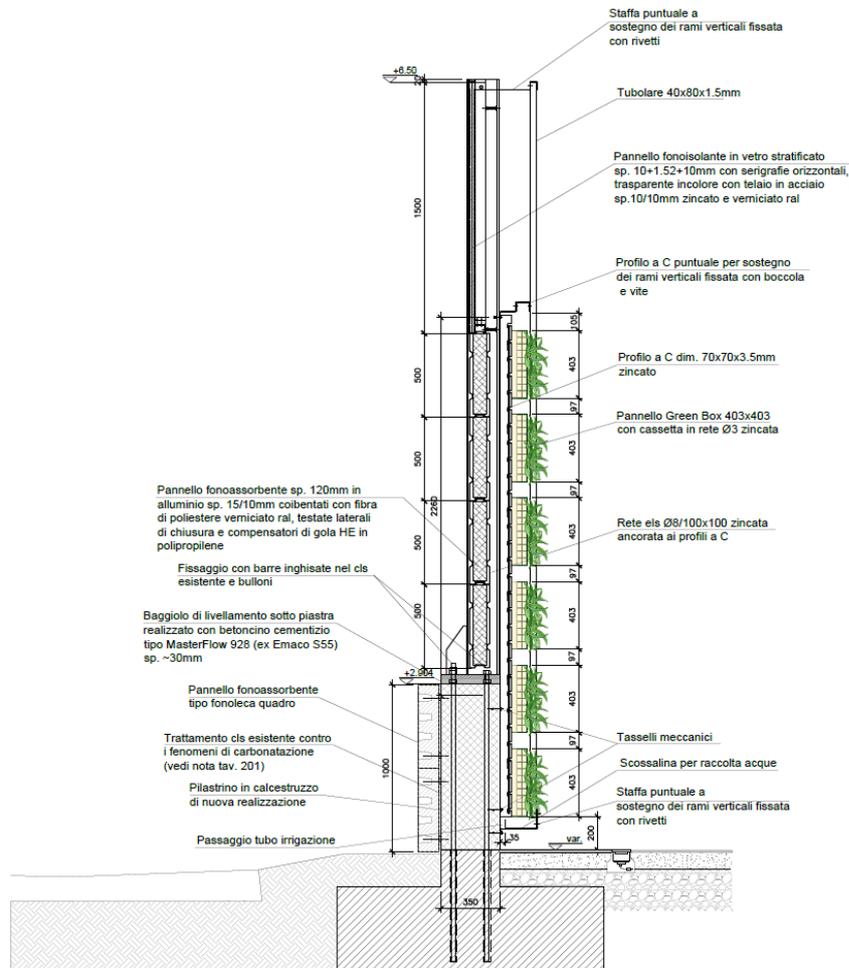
Progetto esecutivo - Protezione antifonica H=4,50 m, sezione tipo (A) – verde.
